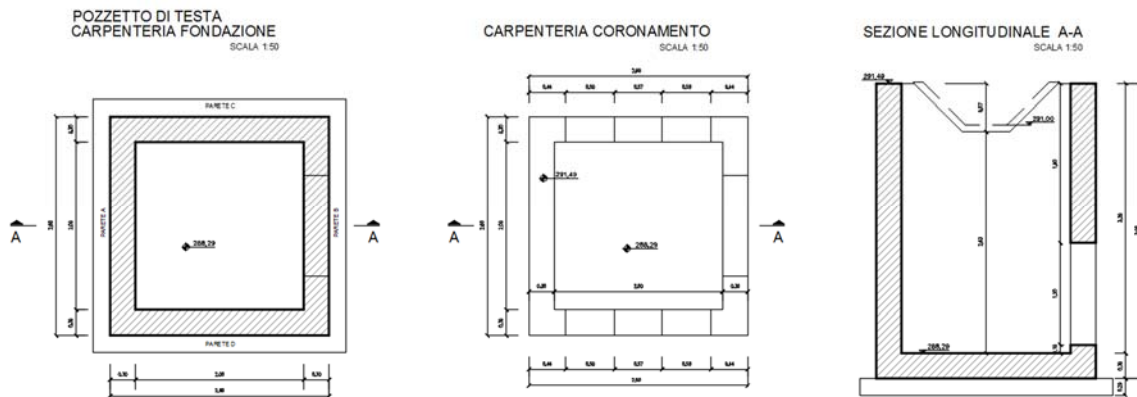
Piante e sezione del pozzetto del tombino TC21
